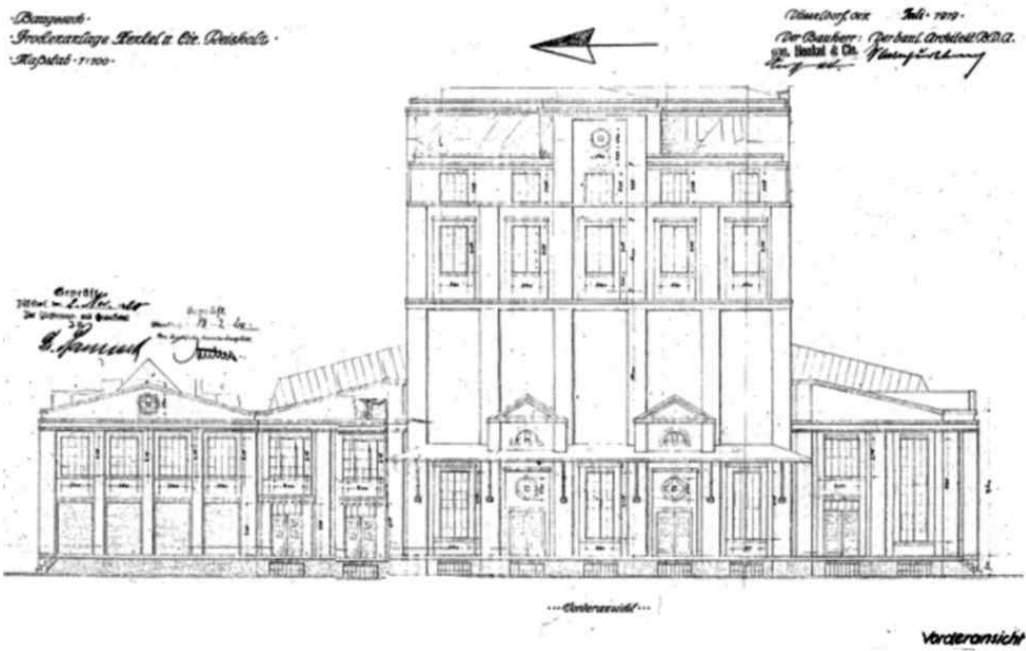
Trocken- bzw. Zerstäubungsanlage Geb. E 07, 1919/ 20 - Architekt: Walter Furthmann
